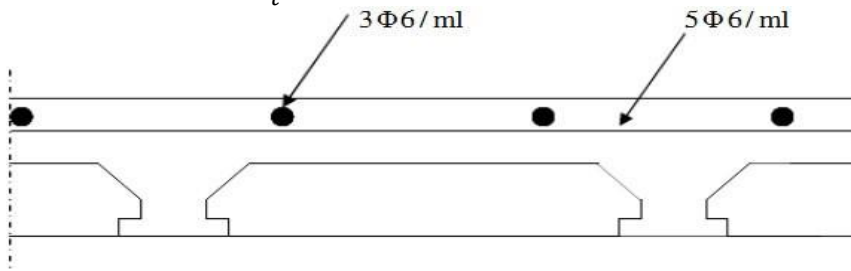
Schéma de ferrailage de la dalle de compression.
